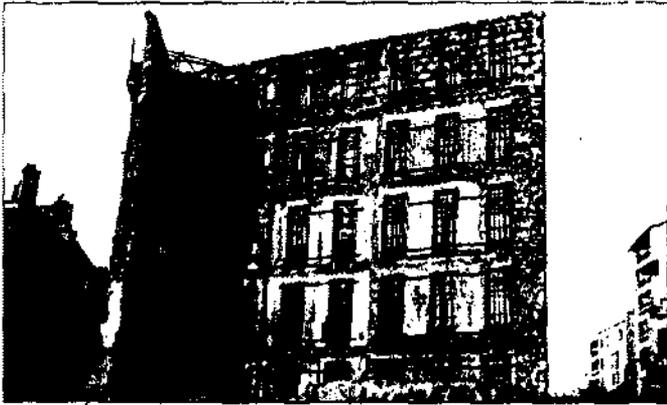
Élançons de façade. Immeuble rue Sainte-Barbe, Marseille.
